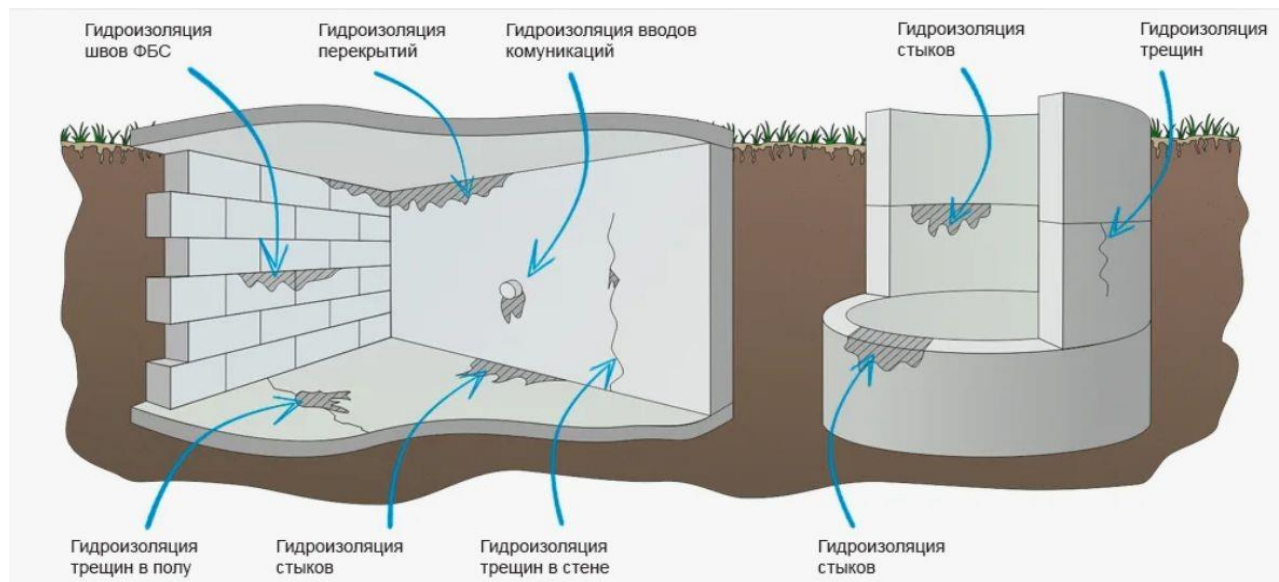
Виды работ по гидроизоляции частей здания, соприкасающихся с грунтом
